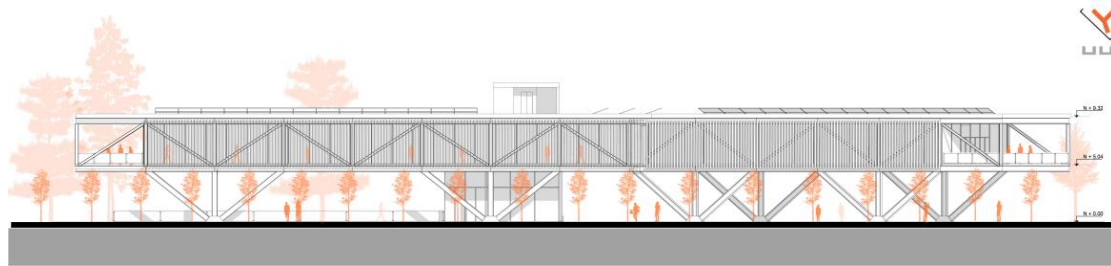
Fachadas Centro Comunitario (Fuente propia)
